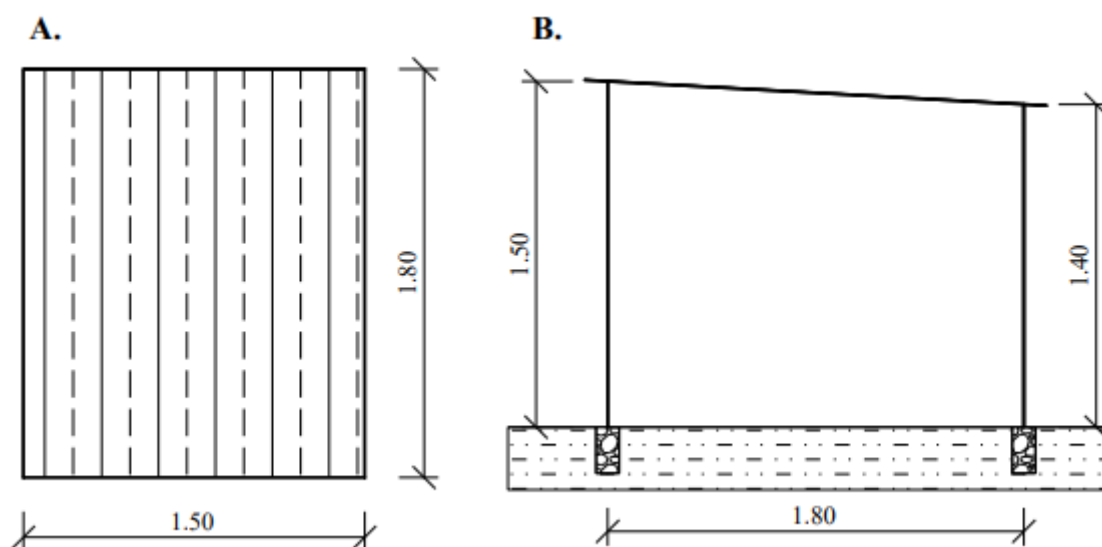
Planta baixa (A) e corte longitudinal do abrigo individual (B)
